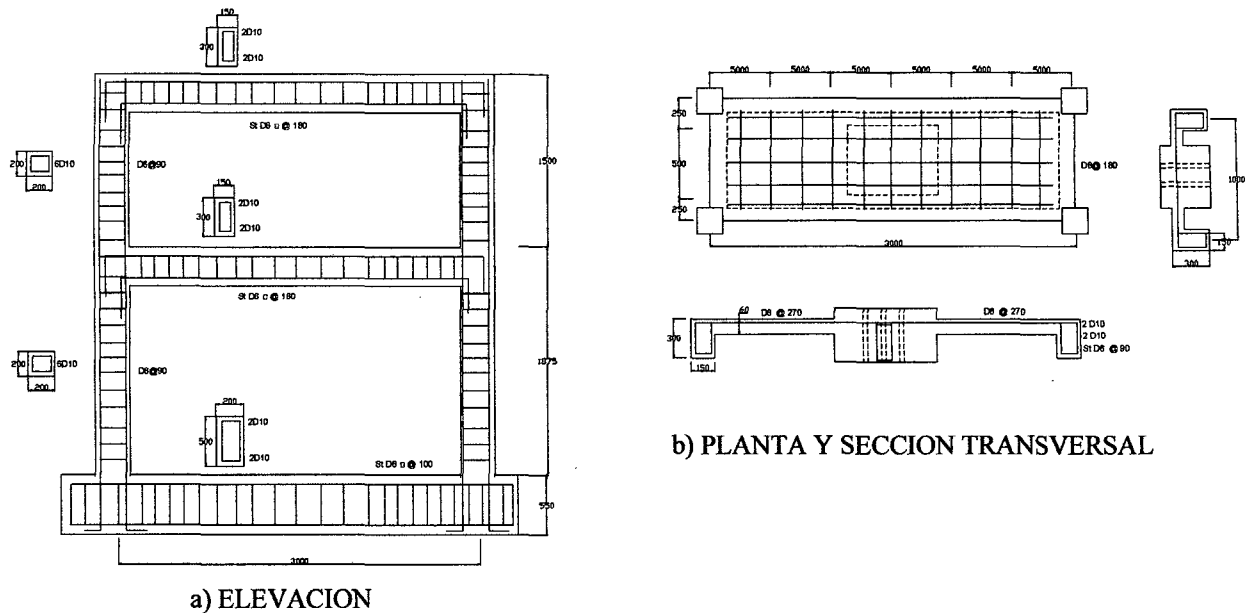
Montaje De Un Espécimen Para El Ensayo On-Line Y Mesa Vibradora En Un Pórtico De Concreto Reforzado De Dos Niveles Y Un Tramo.(Ref.3:pag.18)
